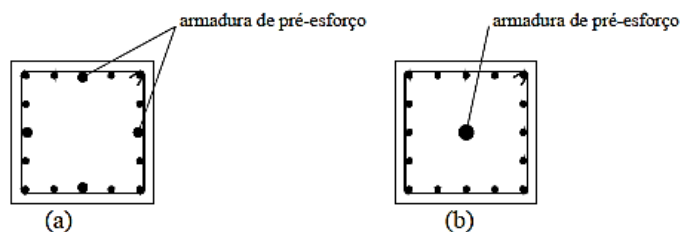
Localização da armadura de pré-esforço na secção transversal de uma viga [13].
